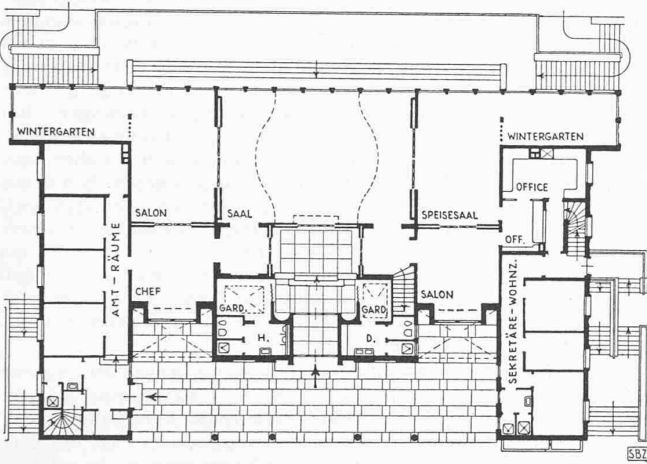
Grundriss vom Erdgeschoss — Masstab 1:400
